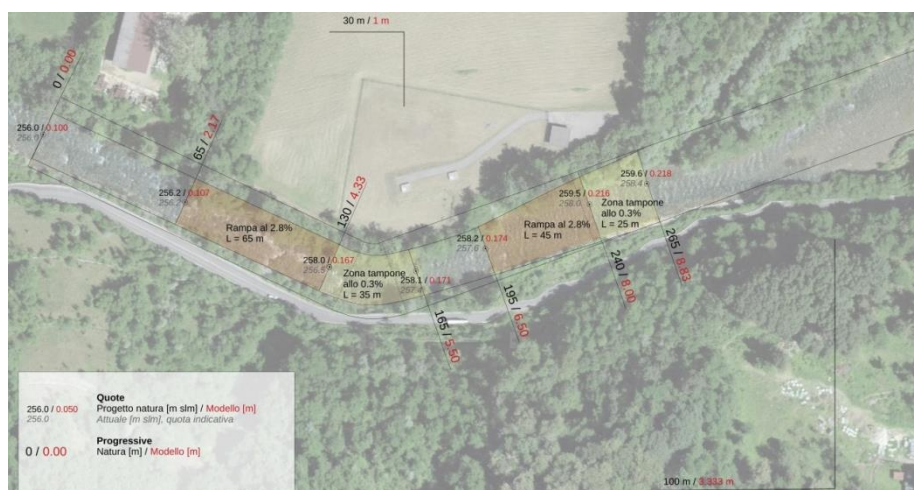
Piano di ubicazione delle rampe di fondo fornito da Laboratorio 3D
